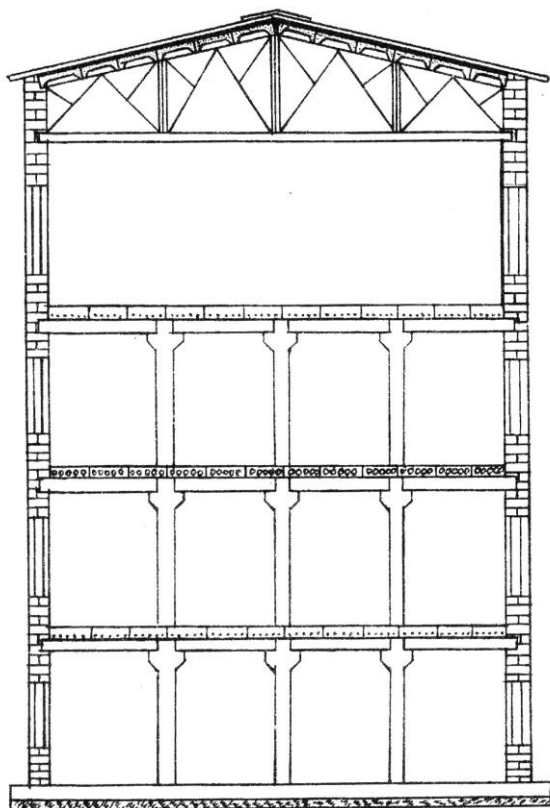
Поперечный разрез первого пожарного отсека проверяемого здания
